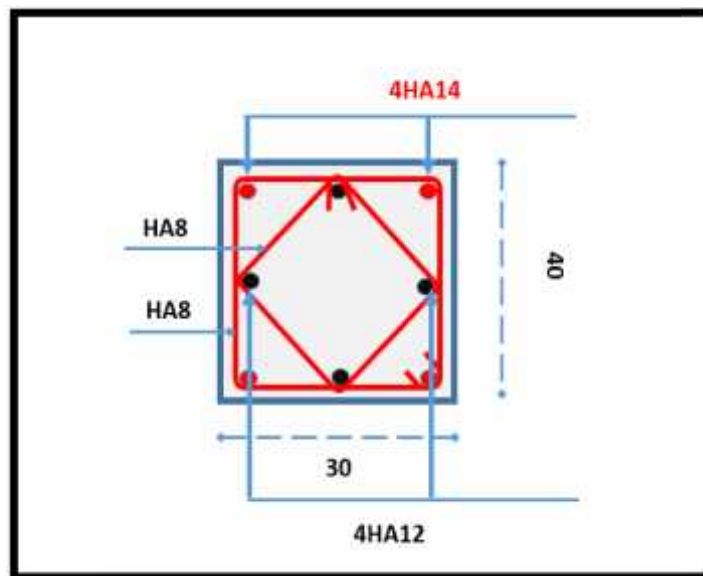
Schéma de ferrailage des Poteaux (40x30)
